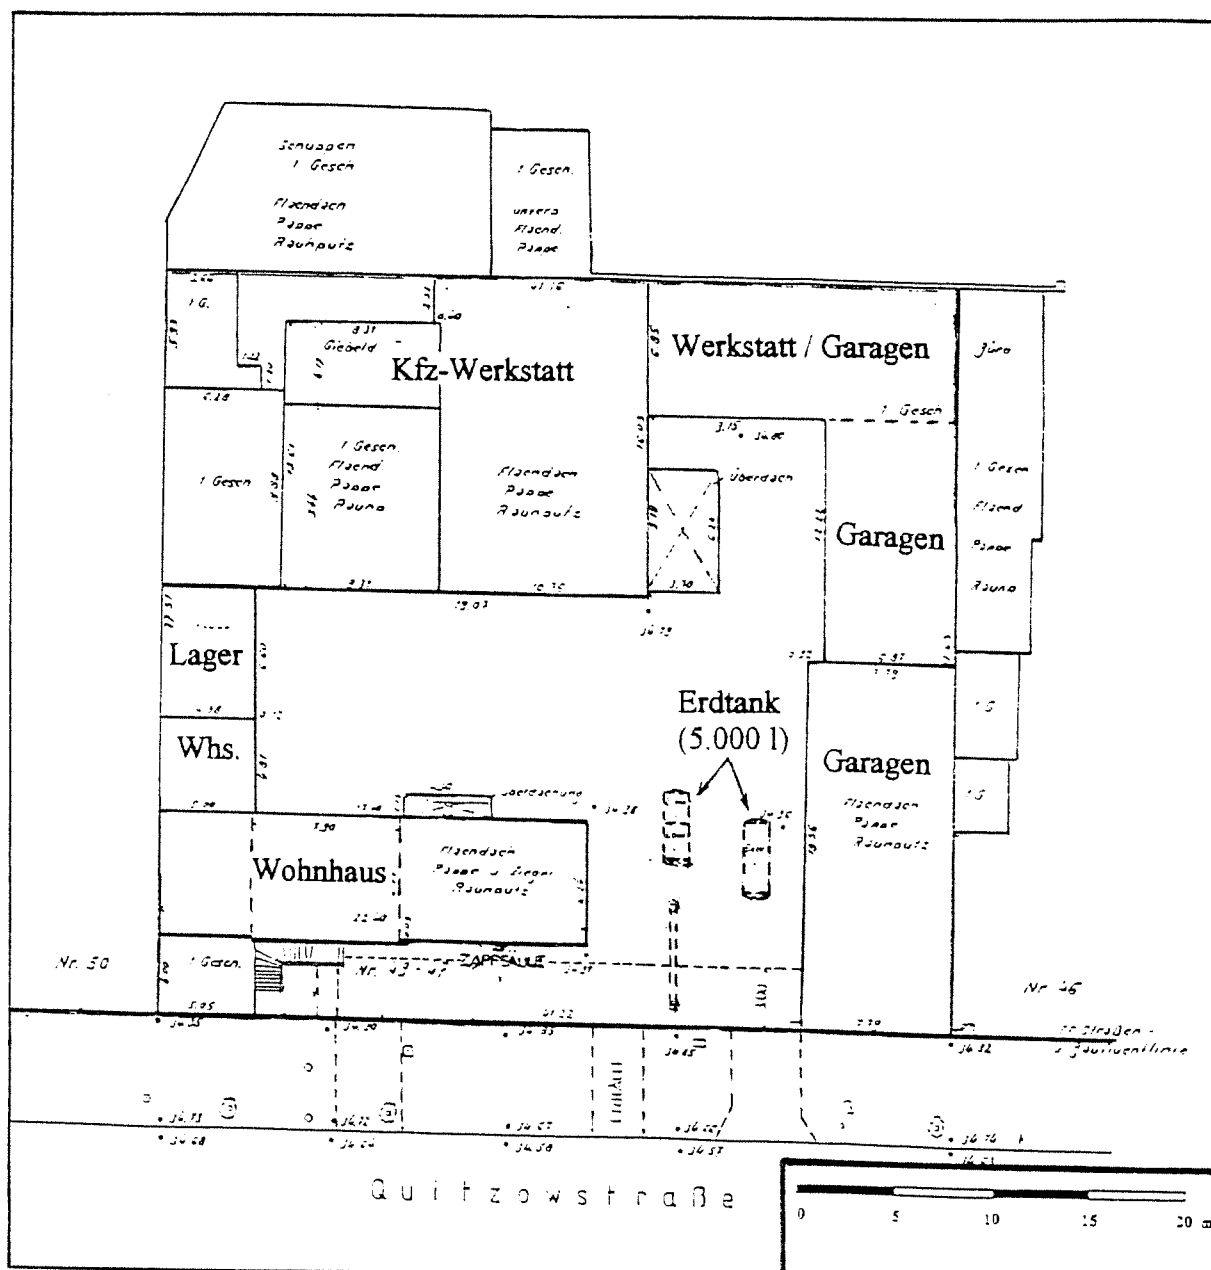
a : Verdachtsfläche 10 - Bebauungssituation 1968 (Nr.47-49)
